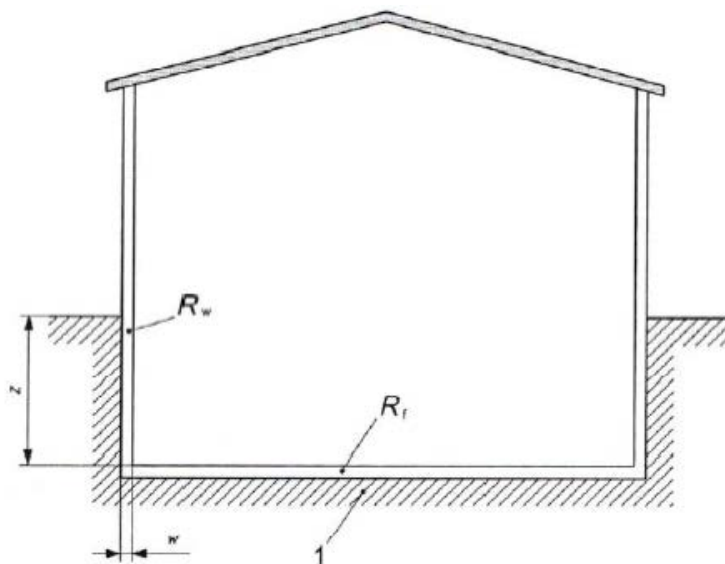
Будинок з опалювальним підвалом (цокольним поверхом):
